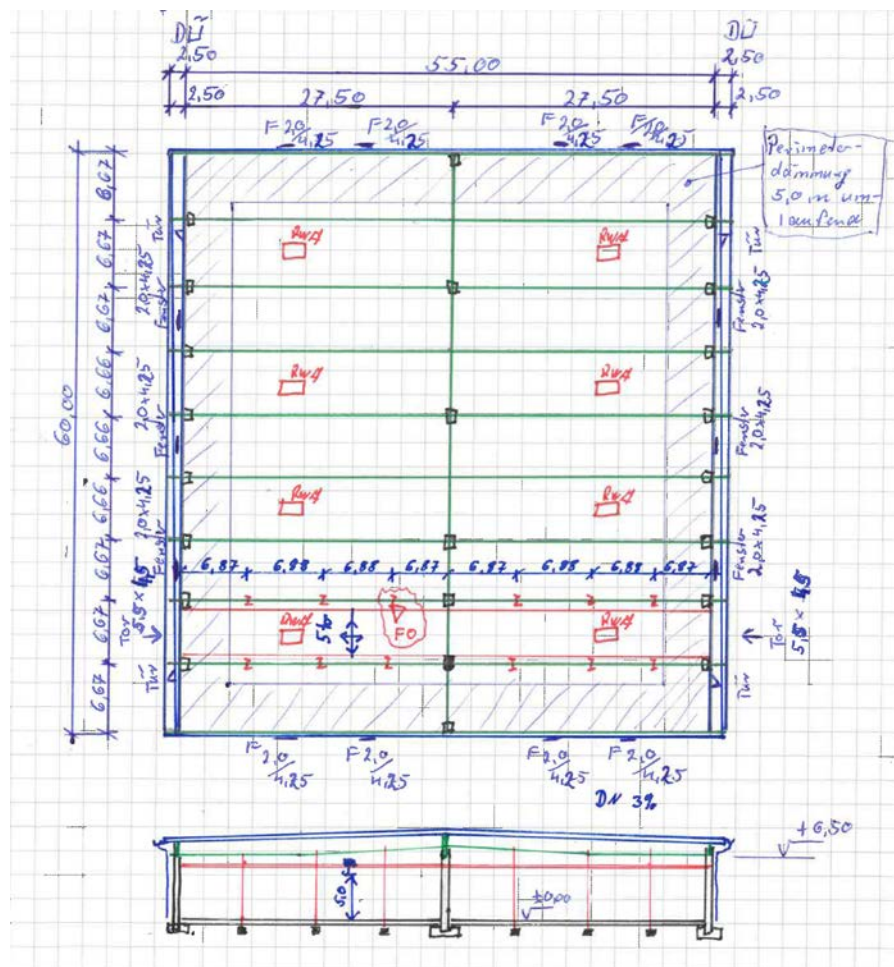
Grundriss-Skizze und Schnitt-Skizze durch die geplante Halle
